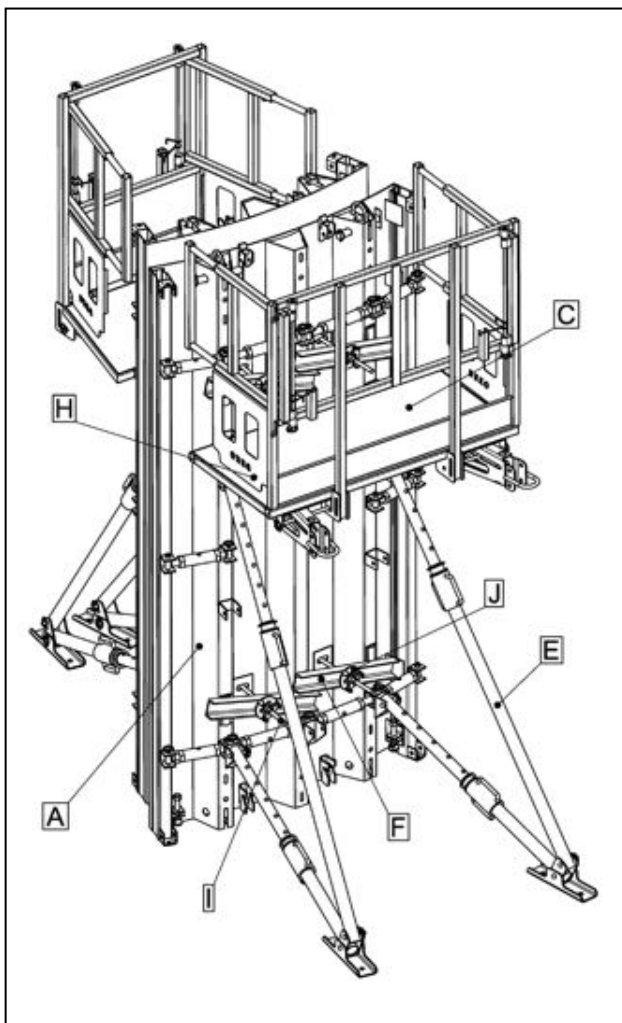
Vue extérieure d'un ensemble FLEXEL
